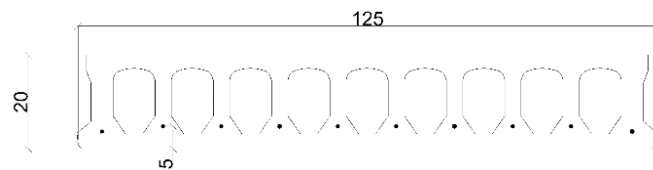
Seção Laje Alveolar H20. (PUMA LAJES ALVEOLARES, 2020)
